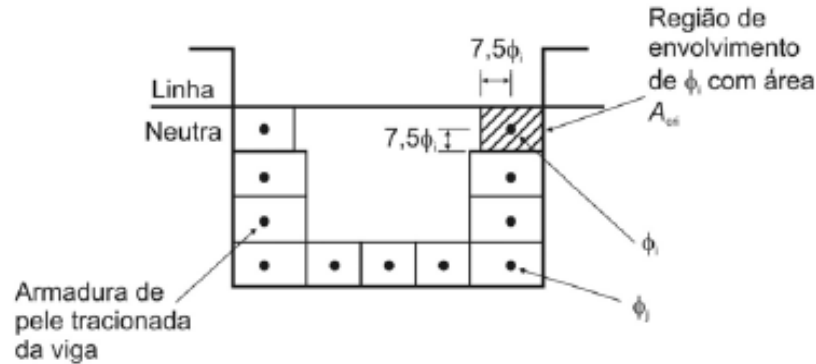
Concreto de envolvimento da armadura (Figura 17.3, da NBR 6118:2007).
